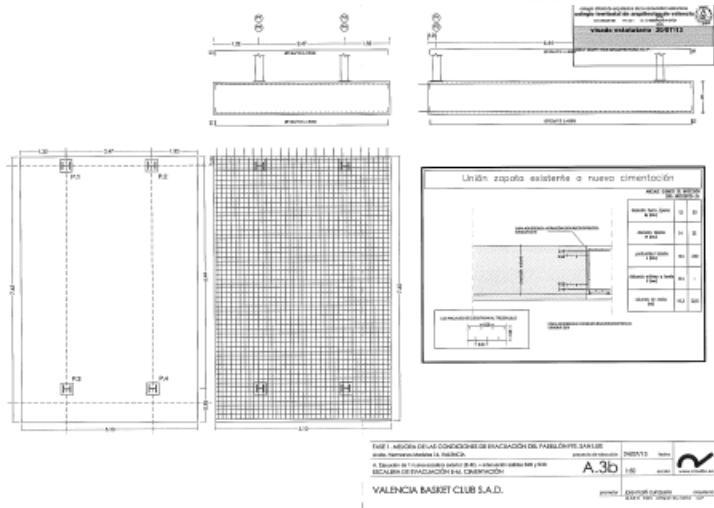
Plano de Cimentación Escalera Exterior E-M. Plano 32.
